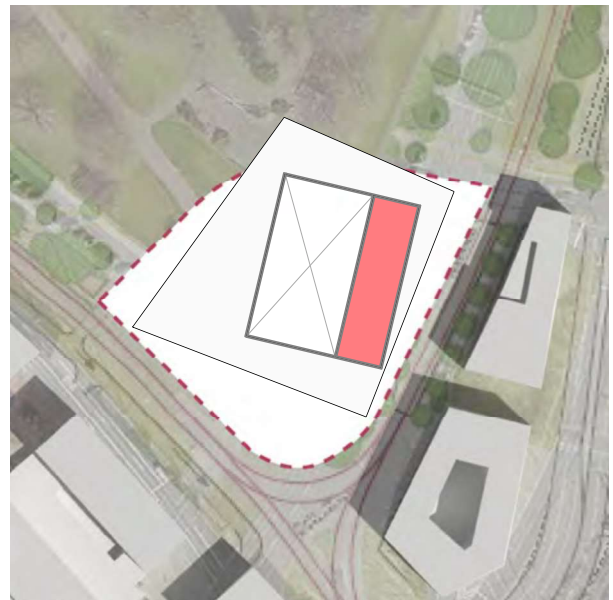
Grundriss OG3 Bahnhofsquartier V1
